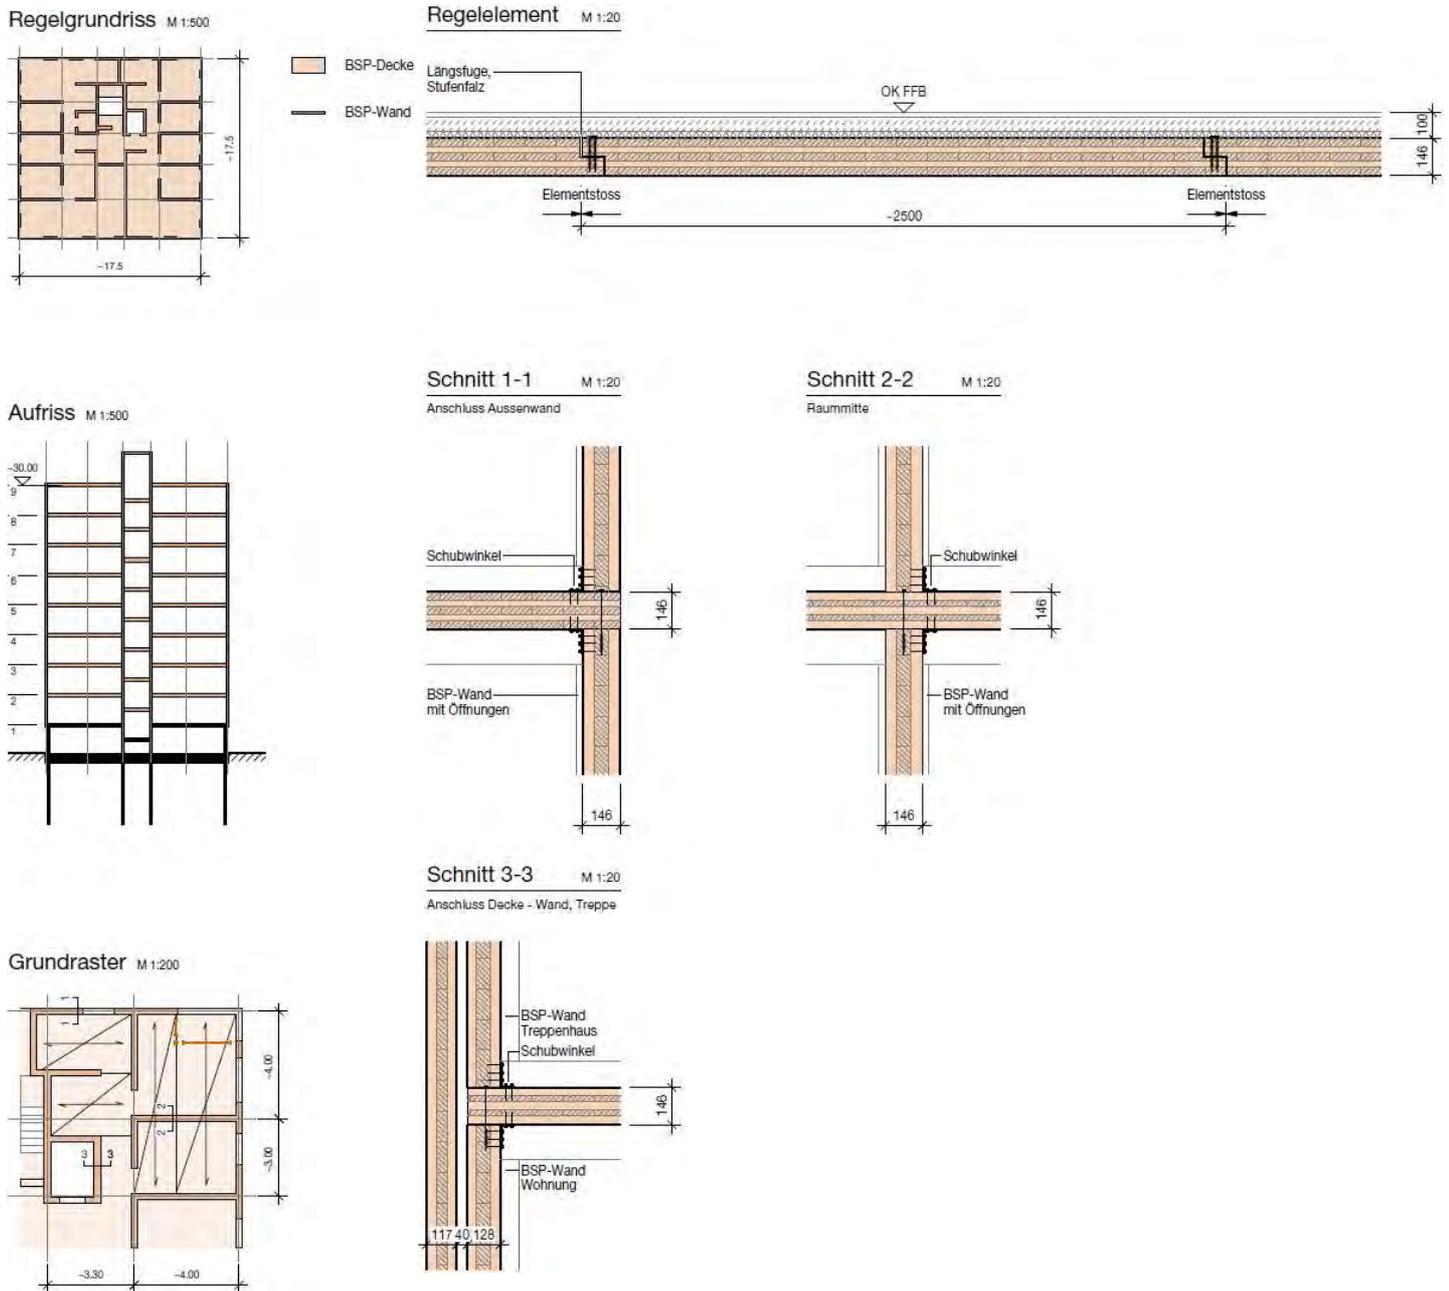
Konstruktionsdarstellung, Murray Grove, London
